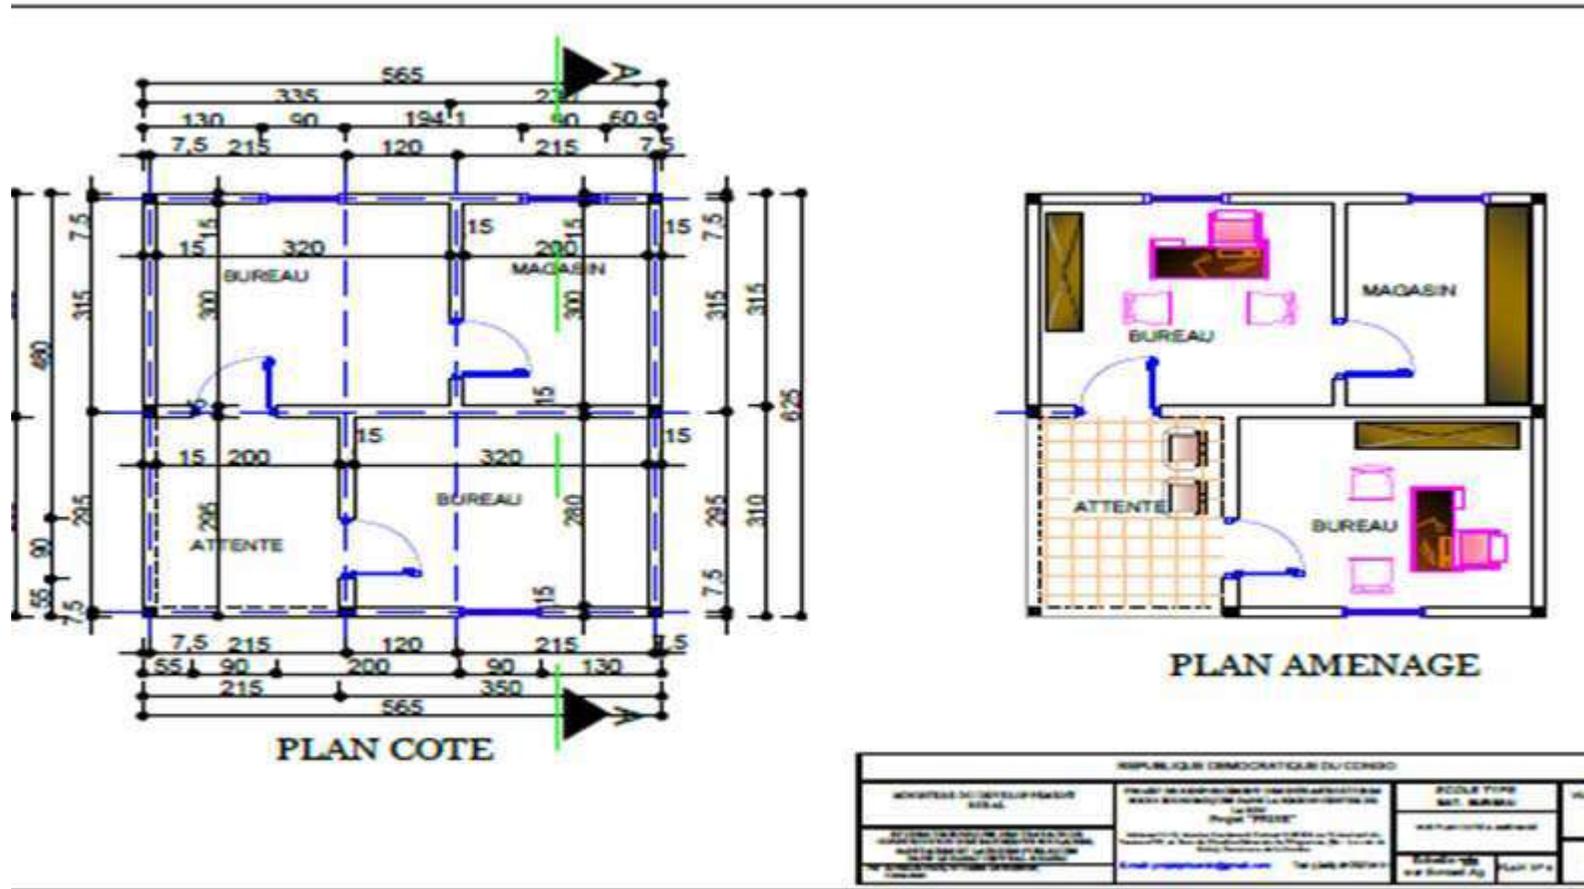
Le plan du bureau administratif à construire sur tous les sites des provinces du Kasai Oriental
